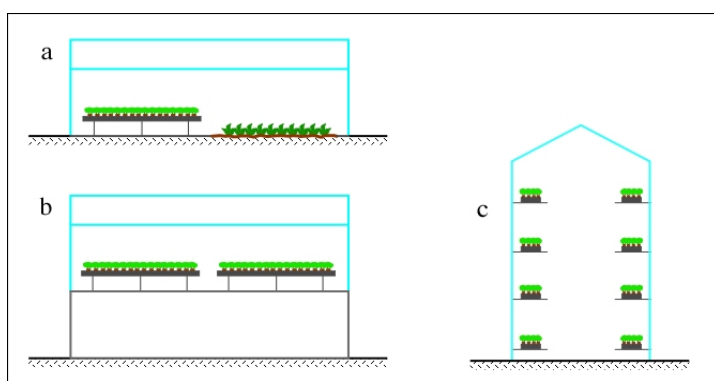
Distribuzione dei piani di coltivazione in una serra: a) in unico piano a livello del terreno; b) in unico piano ad una quota sopraelevata rispetto al terreno; c) su più piani.
